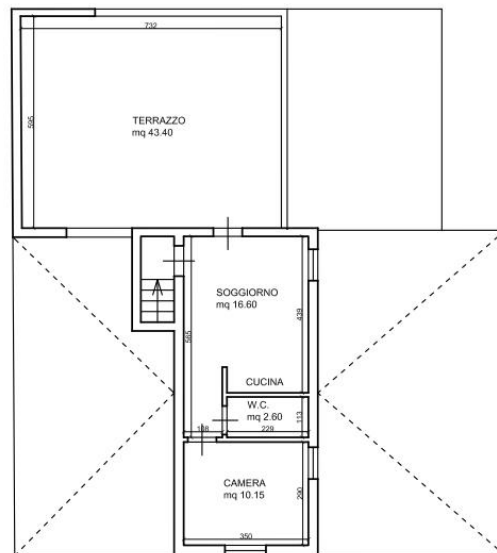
Planimetria bene pignorato ai fini della vendita all'asta
